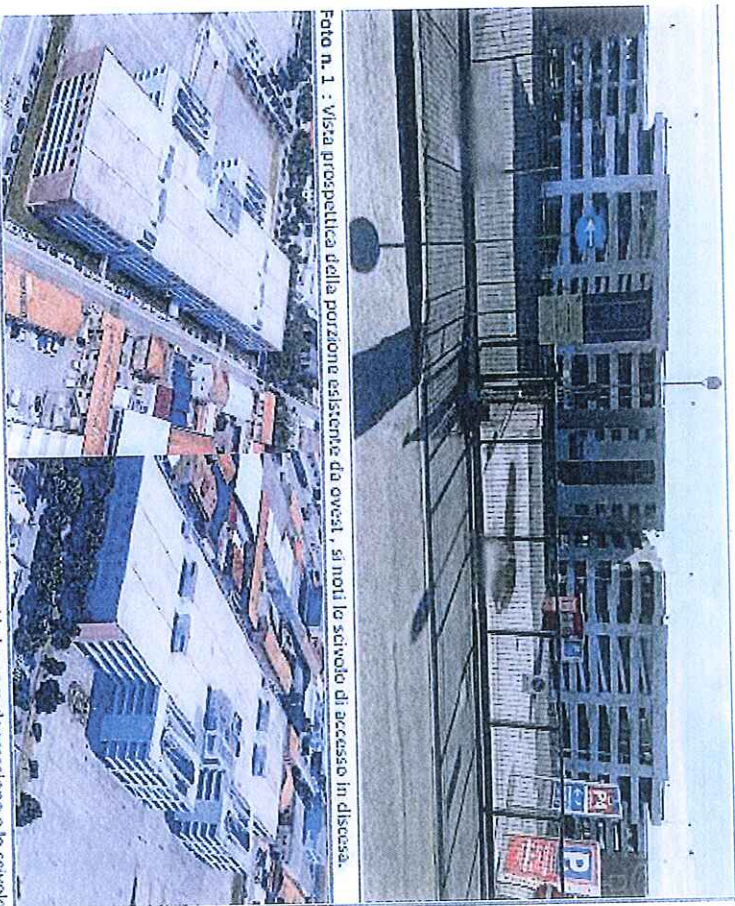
Vista prospettica della porzione esistente da ovest, si noti lo scivolo di accesso in discesa.
